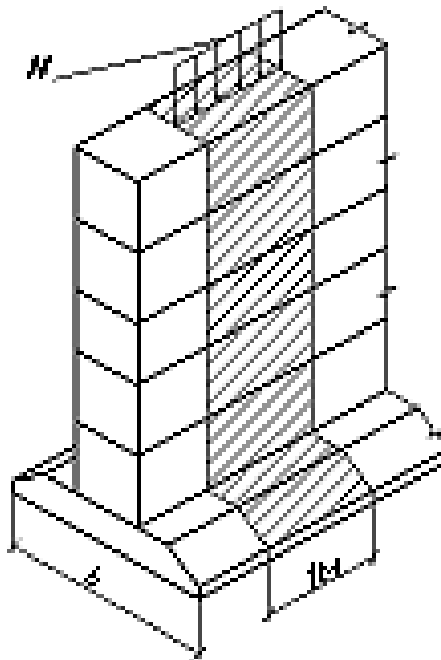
Збір навантажень на 1 м пог. фундаментної подушки
